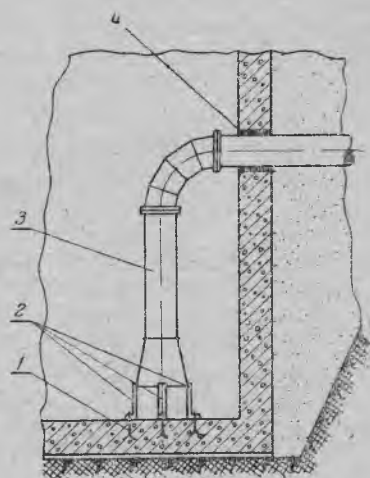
Крепление всасывающей трубы к днищу водоприемной камеры:
